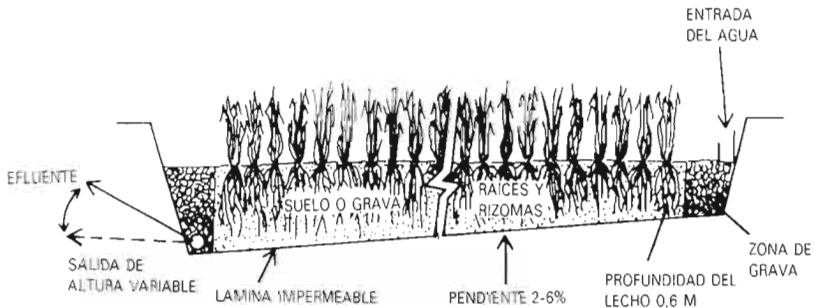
Esquema de un sistema típico de depuración con plantas emergentes (sección longitudinal).
